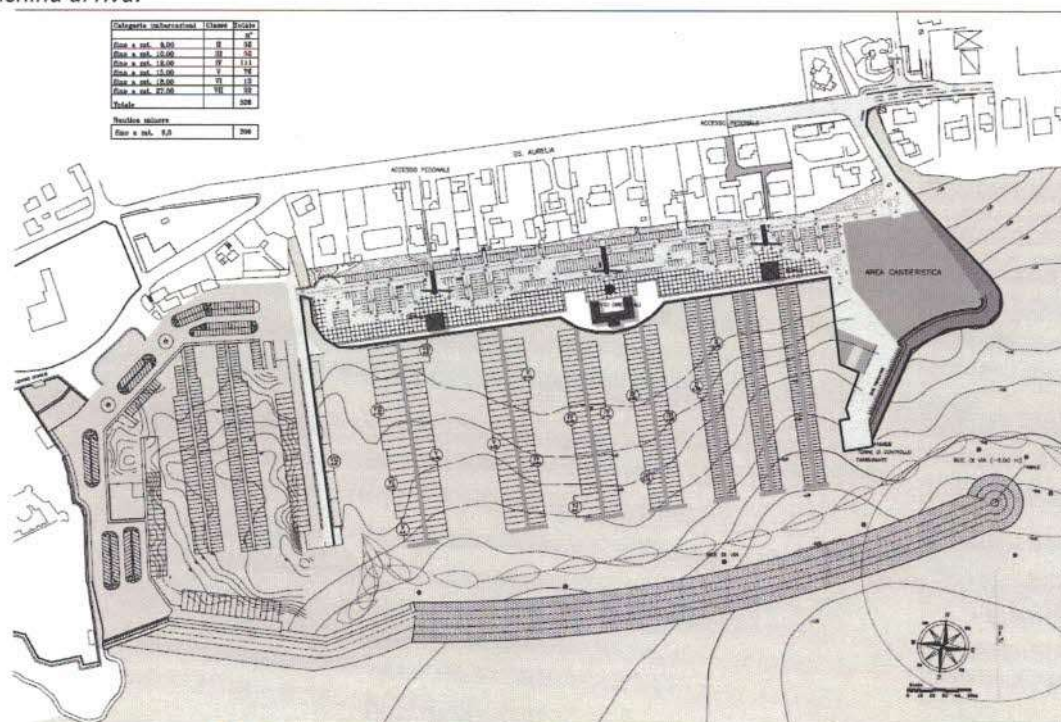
Planimetria di progetto con indicazione delle opere da realizzare
